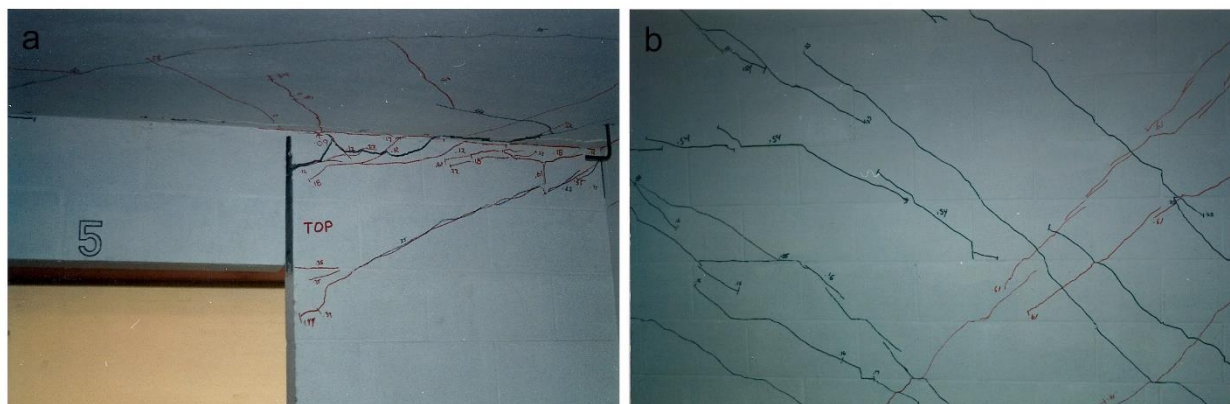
Grietas o fisuras en la losa de la azotea o nivel 5, y en la pared Este del nivel 2. En color negro se indican las grietas resultantes a la compresión y en rojo a la tensión. Fotografía: Luis H. Mendoza, 1992.
